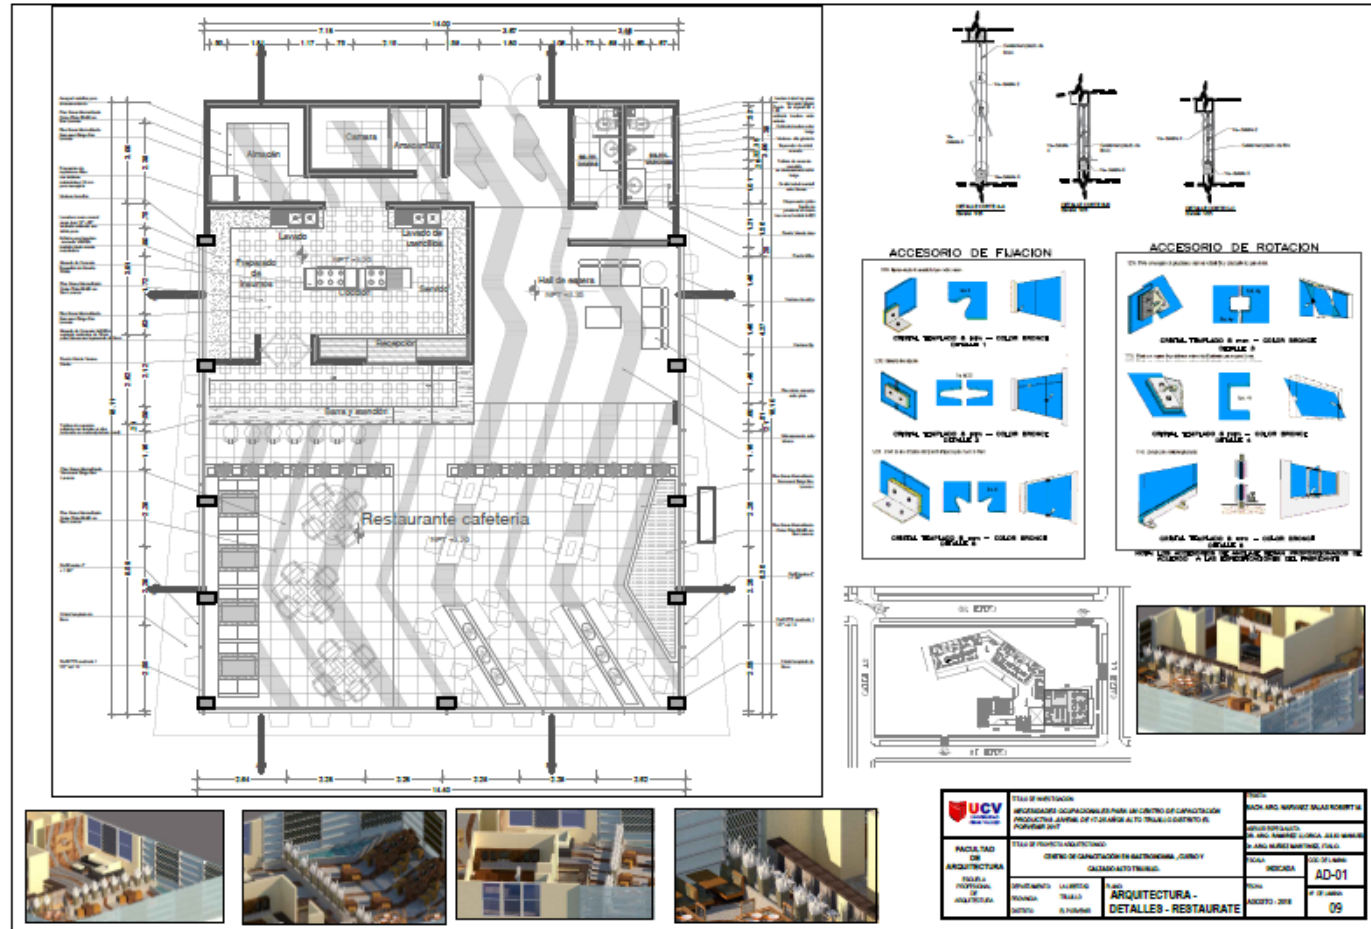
Plano de Detalle Arquitectónico planta general de restaurante -Plano N°09-Lámina AD01
